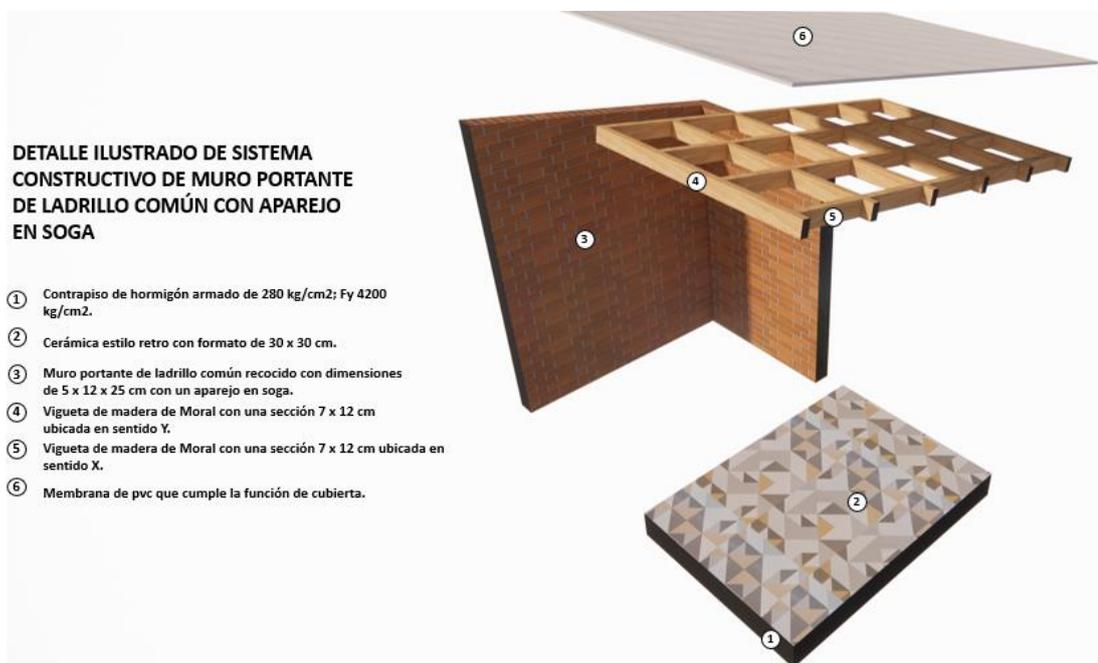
Detalle constructivo de muro portante de ladrillo común en axonometría.
